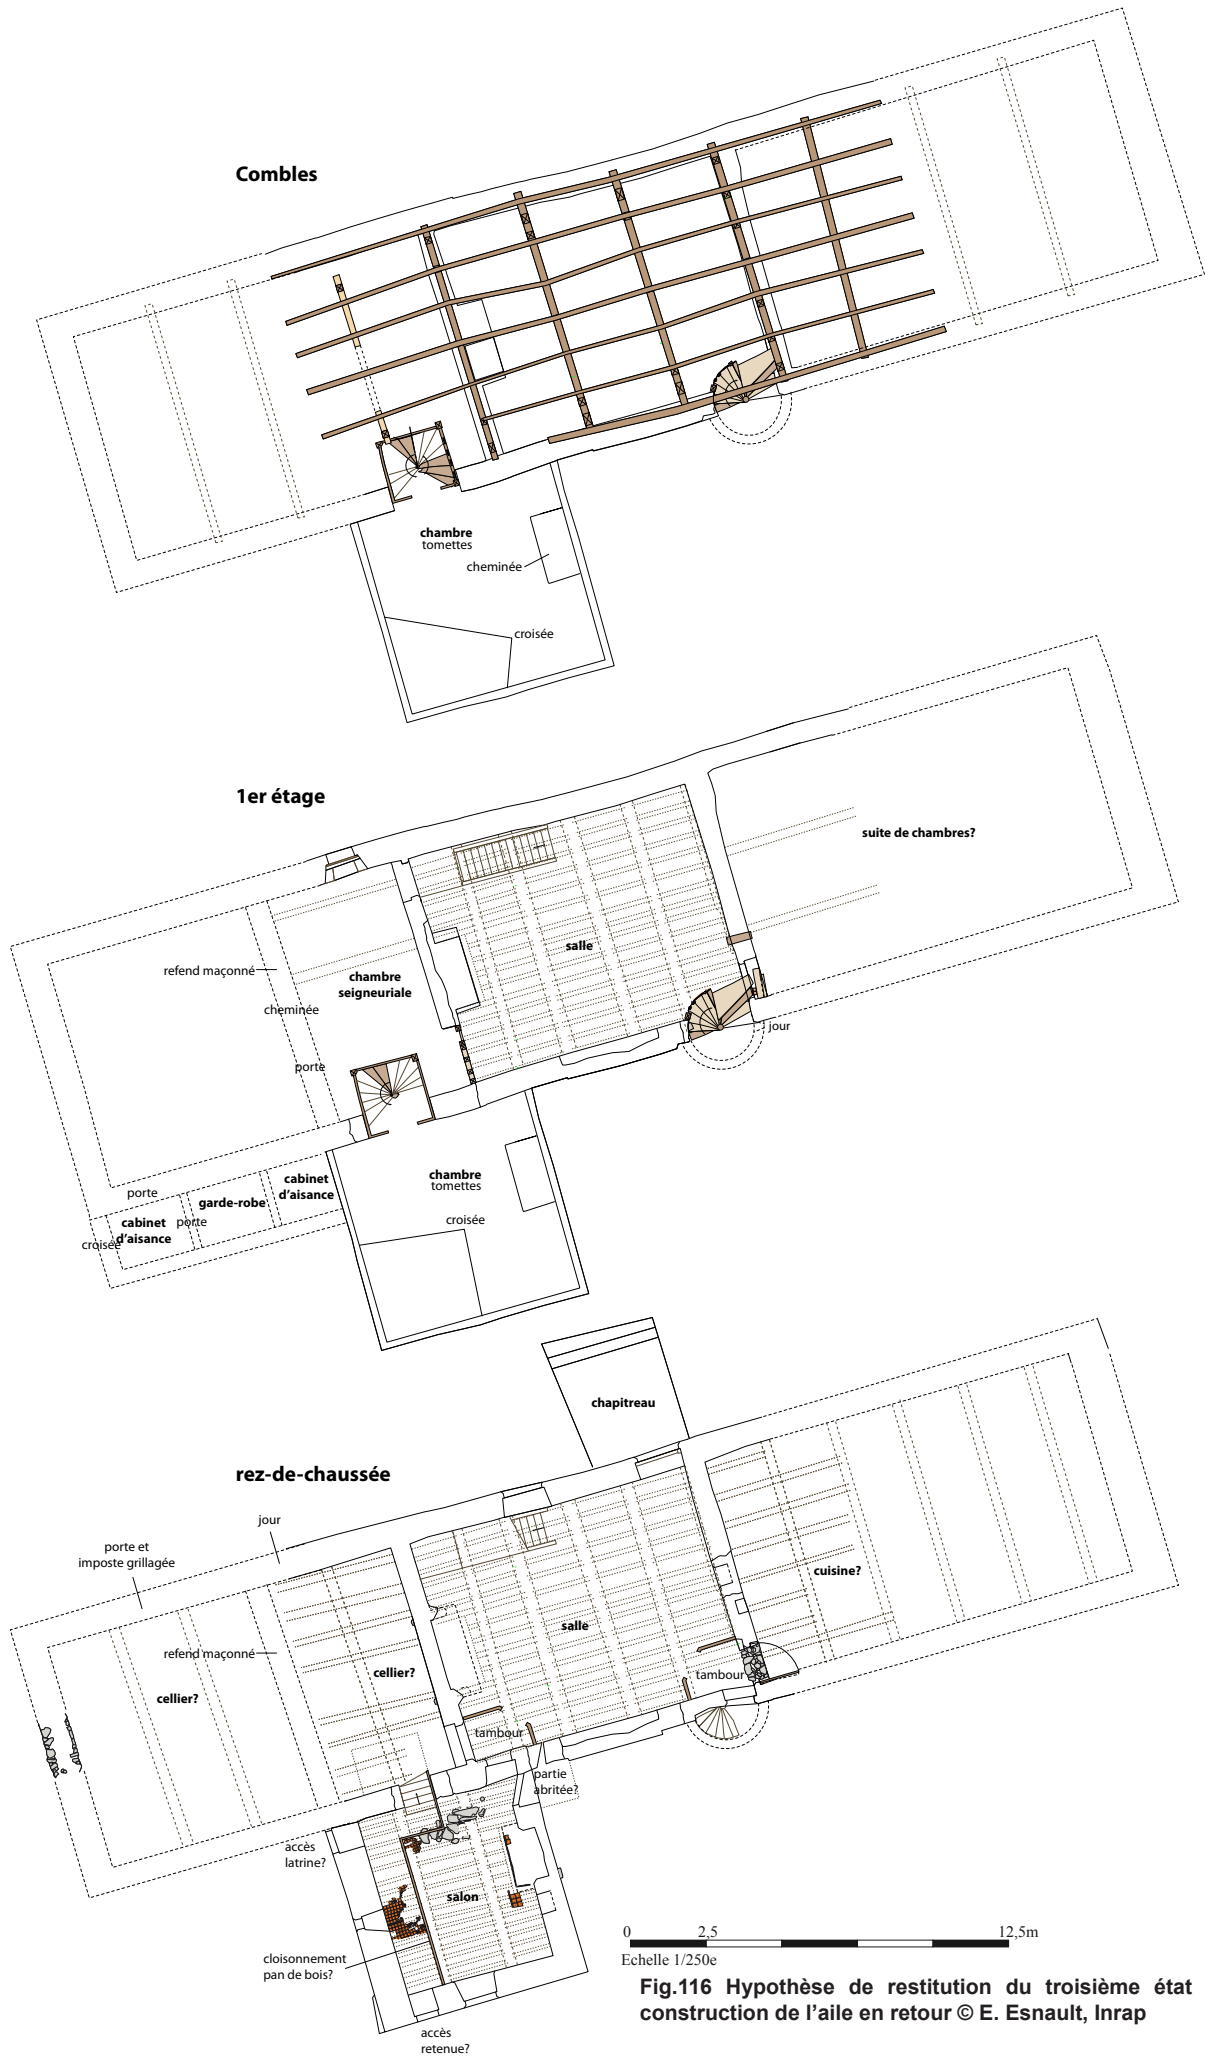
Hypothèse de restitution du troisième état : la construction de l'aile en retour © E. Esnault, Inrap
